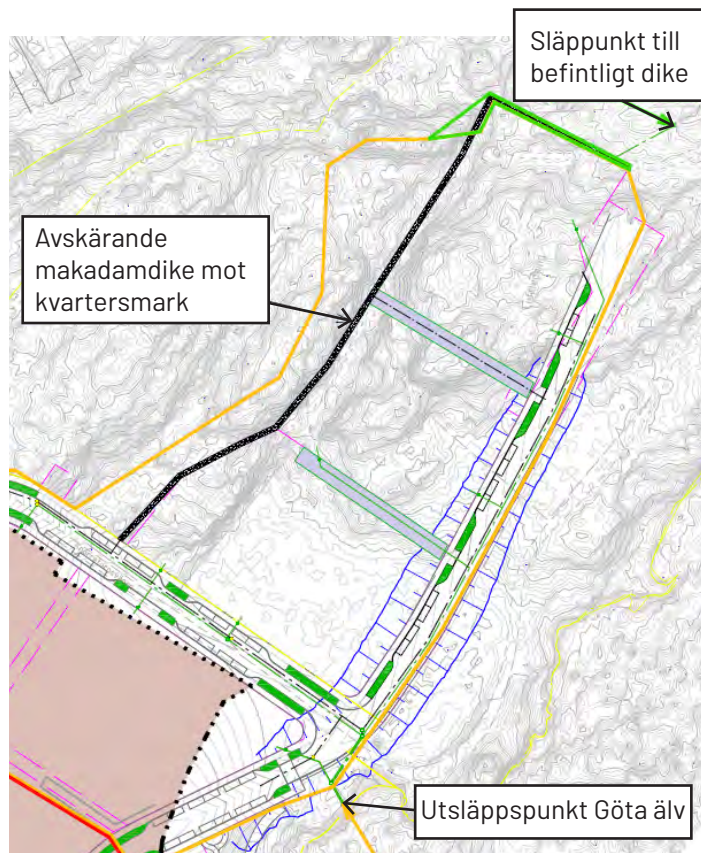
Förslag till dagvattenhantering, ALP 2020-02-28, bilaga 5
